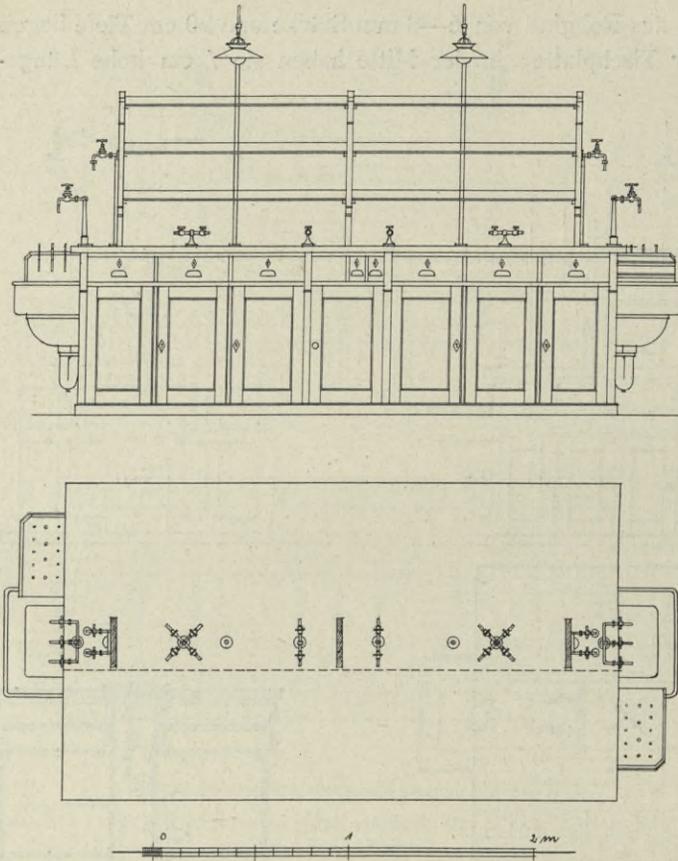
b. Grundrisse zu Abb. 123.
